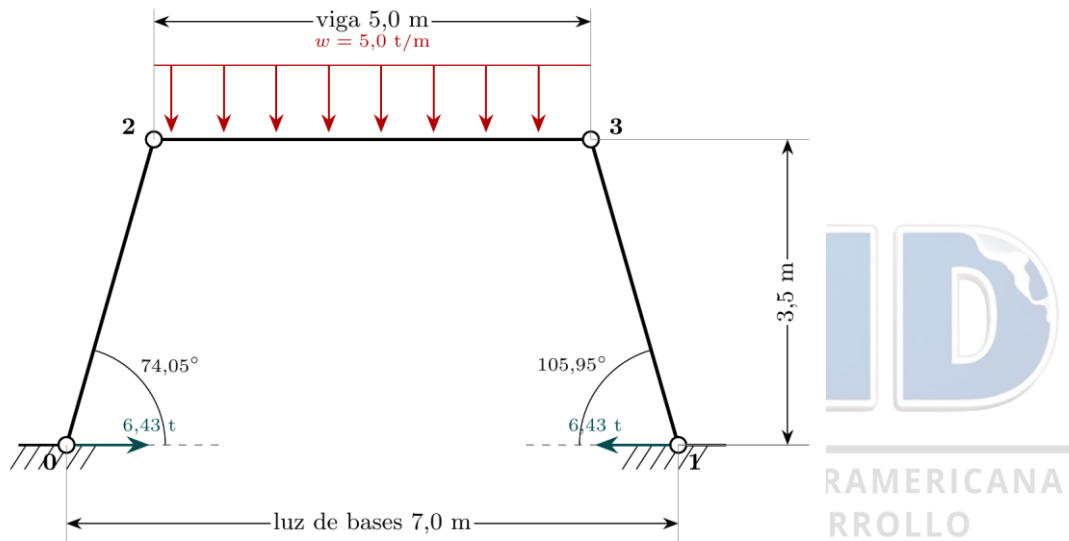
Idealización del pórtico trapezoidal del Ejercicio 4.4: columnas inclinadas ($\alpha = 74,05^\circ$ y $105,95^\circ$), viga horizontal cargada y el empuje horizontal de 6,43 tonf que las columnas inclinadas transmiten a las bases.
